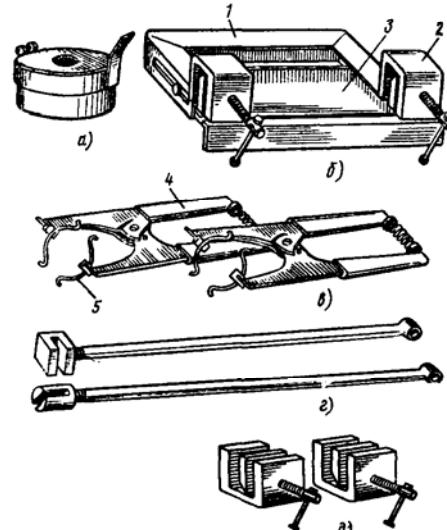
Принадлежности для термитно-тигельной сварки стальных полос и стержней заземления:
